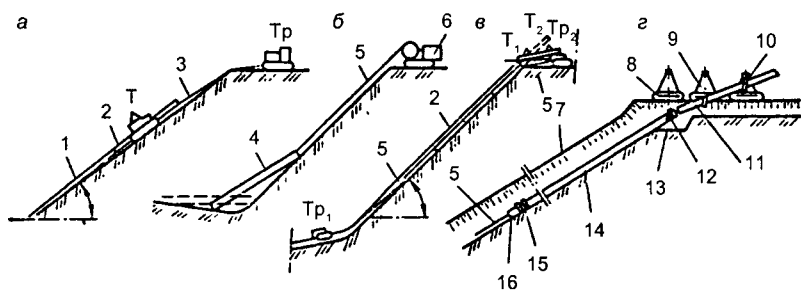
Схемы укладки трубопроводов на склонах оврагов и балок при строительстве дюкеров:
